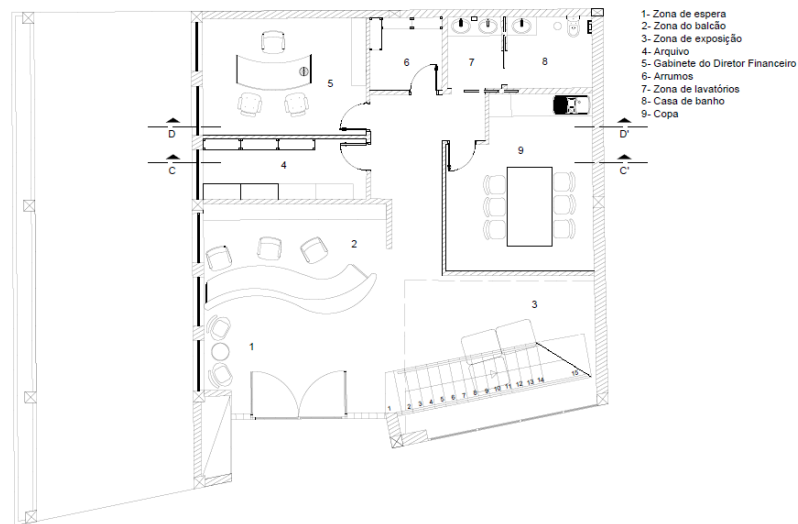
Planta de apresentação do piso 0, em Autocad. *Fonte:* Ana Cândido.
